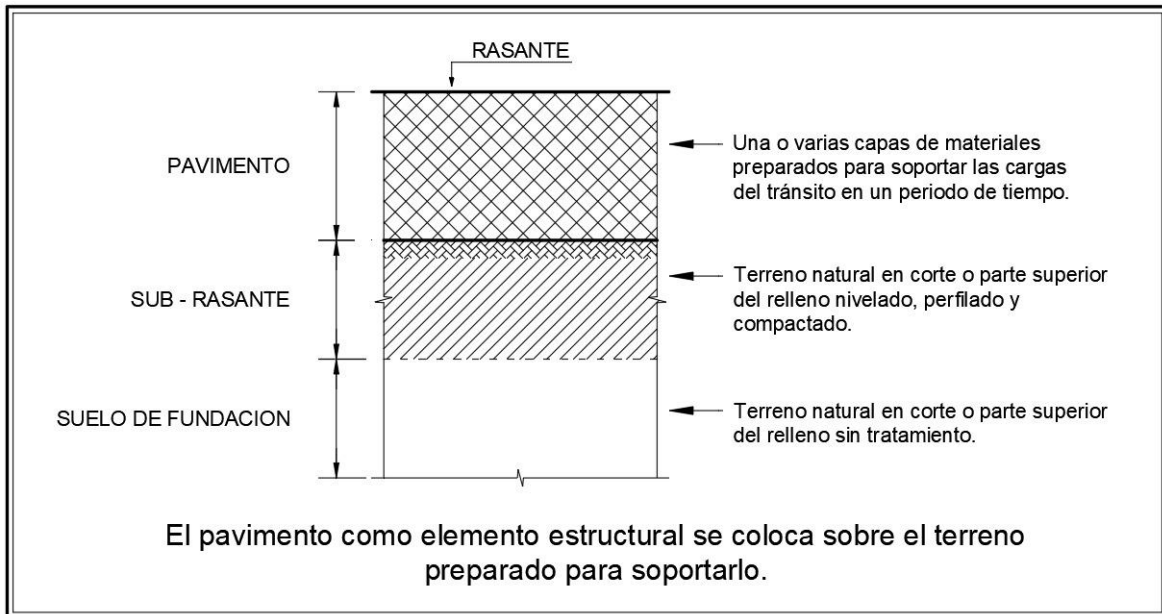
Pavimento como elemento estructural. Adaptado de (VIVAR, 1995)
